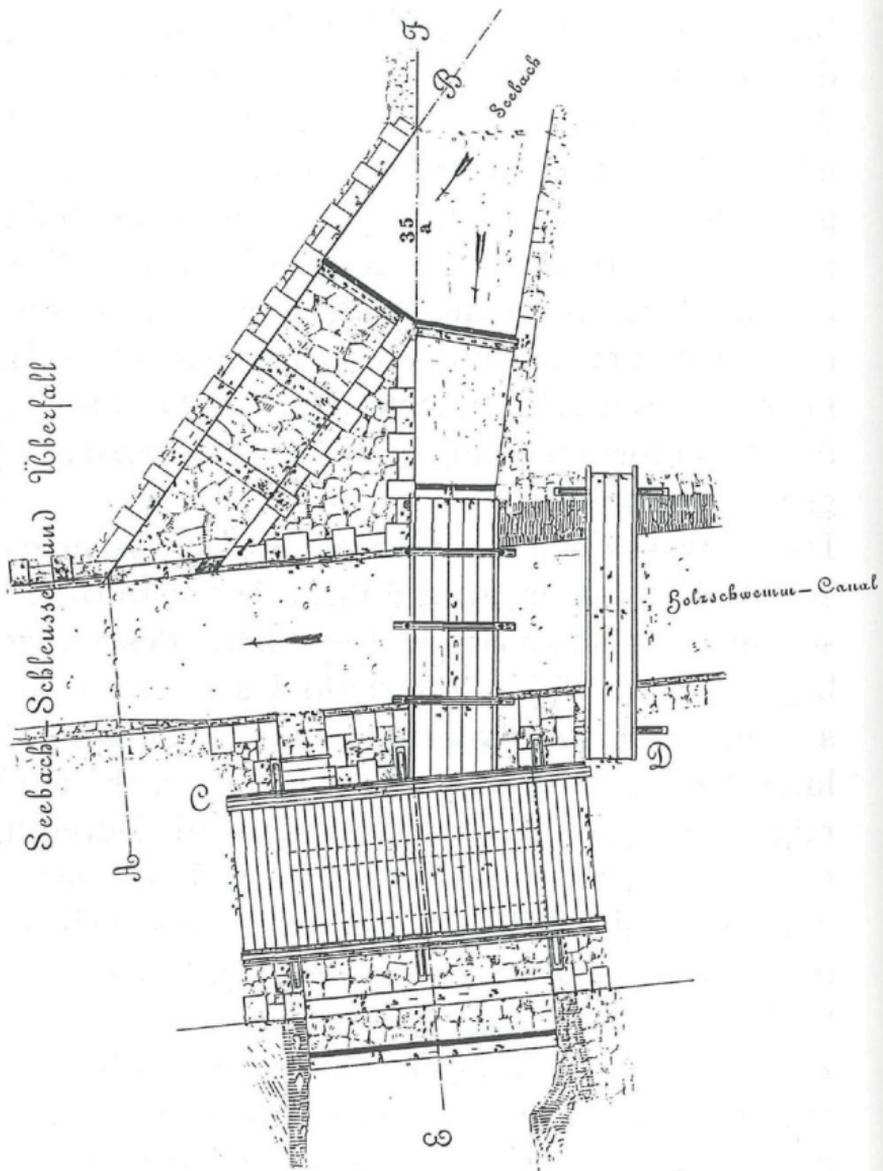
Seebach-Schleuse und -Überfall, Grundriß
